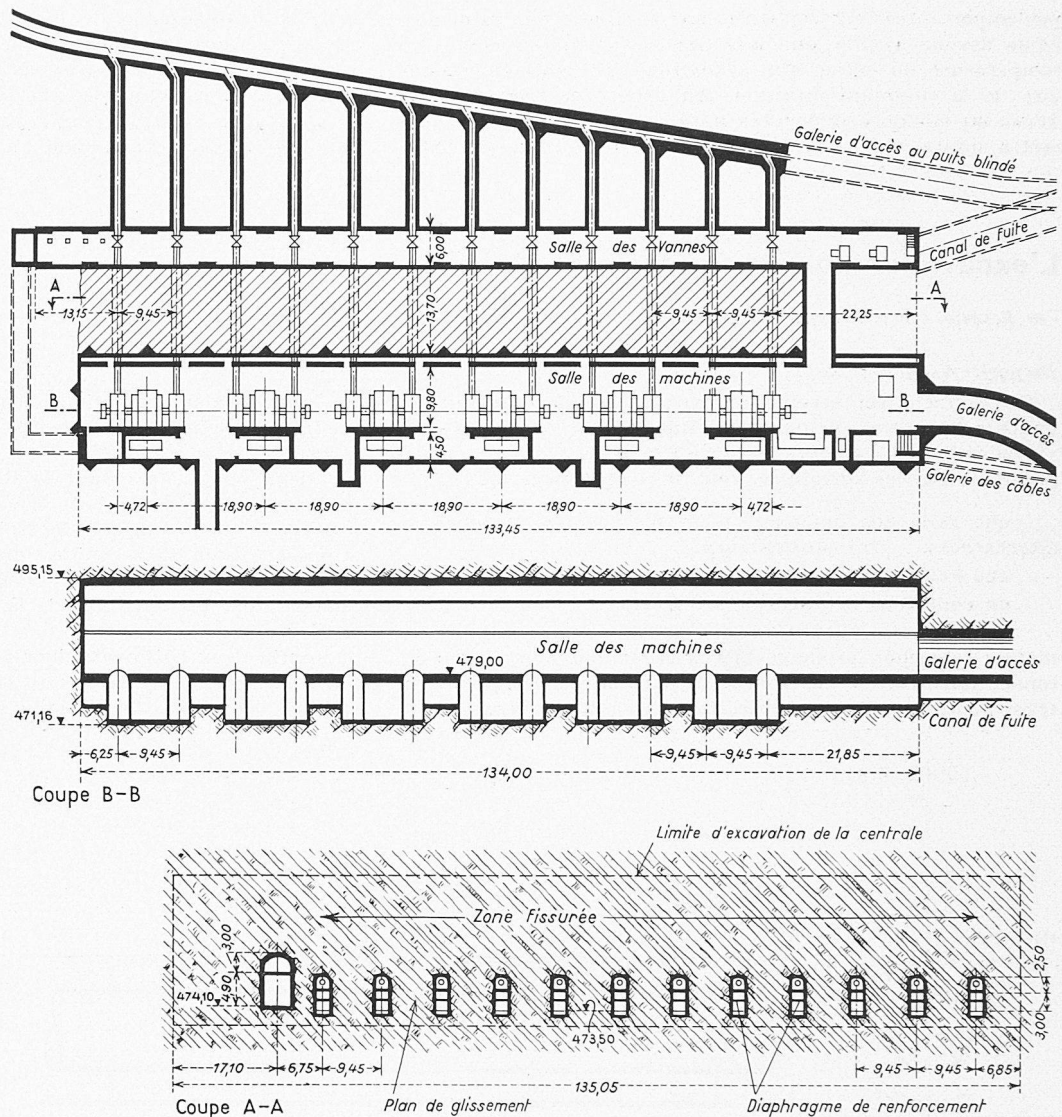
Centrale de Nendaz, plan et coupes longitudinales 1:1200
